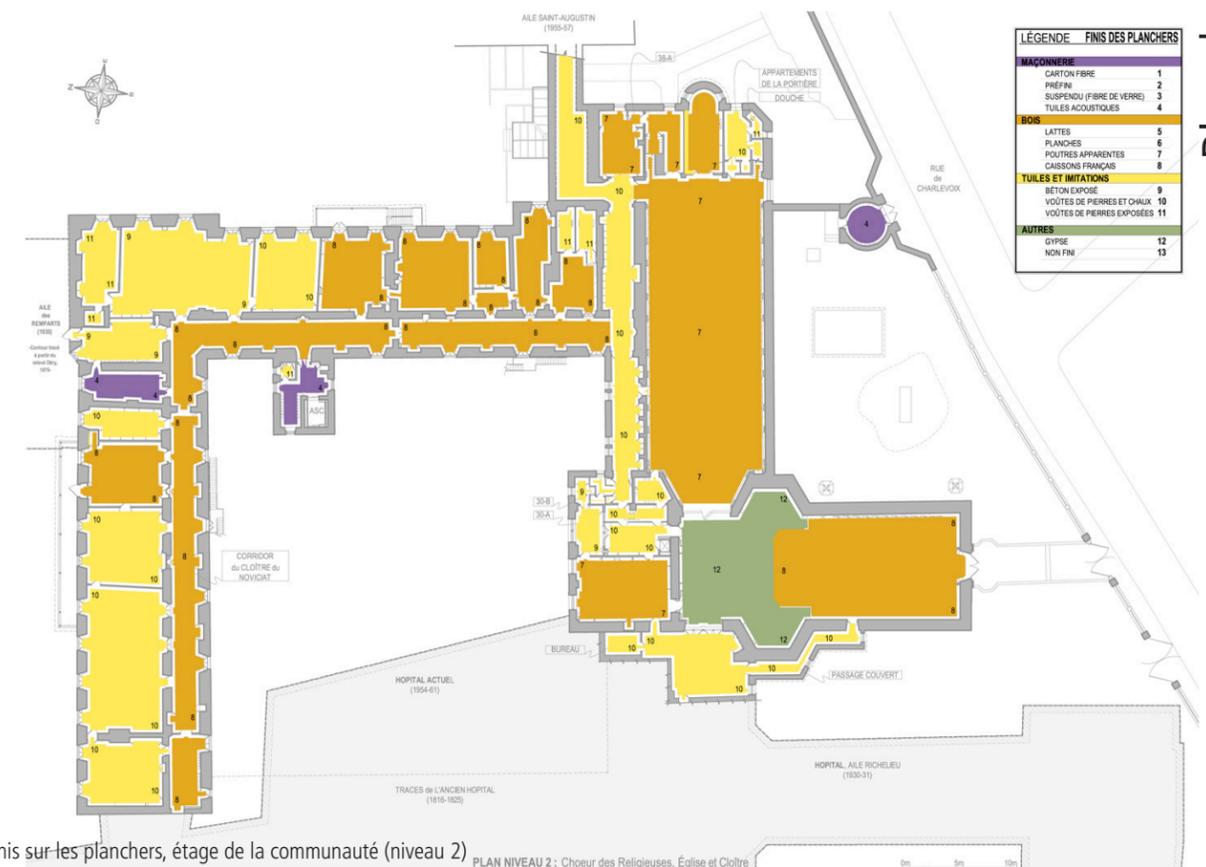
Plan des fins sur les planchers, étage de la communauté (niveau 2)
